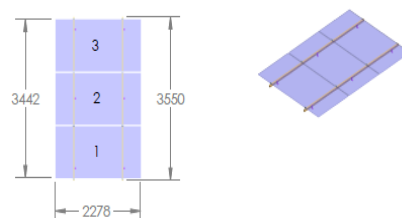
Arreglo de paneles en la estructura implementada para el diseño
